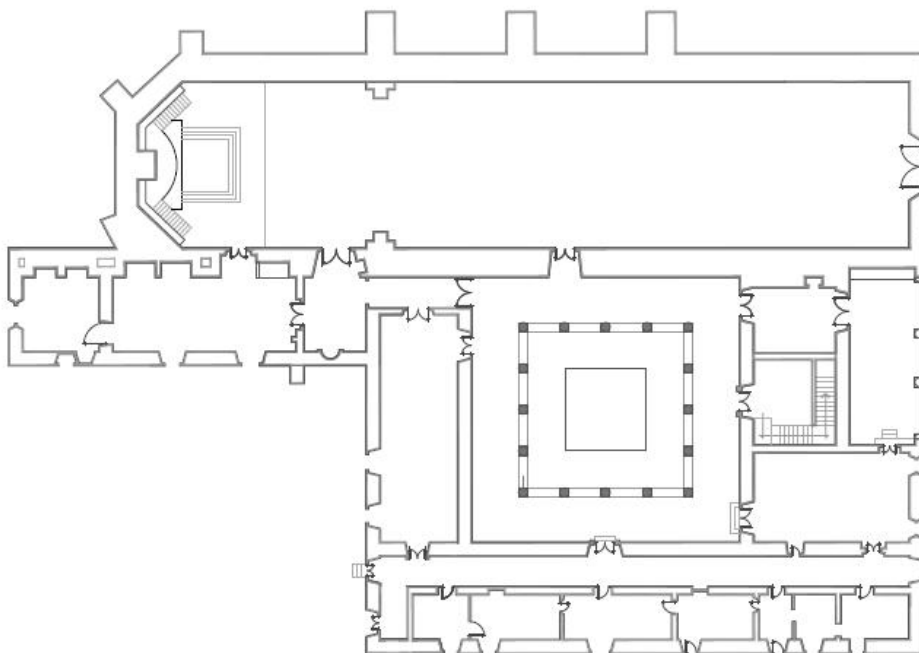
Planta arquitectónica, etapa constructiva 1629-1635⁵⁷
